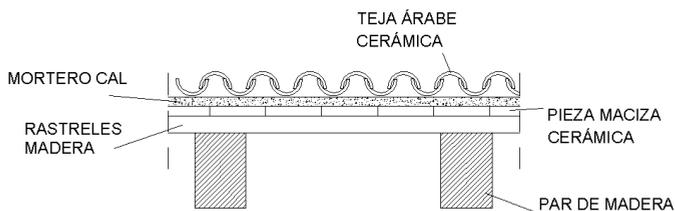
Detalle sección de cubierta inclinada.2015.
